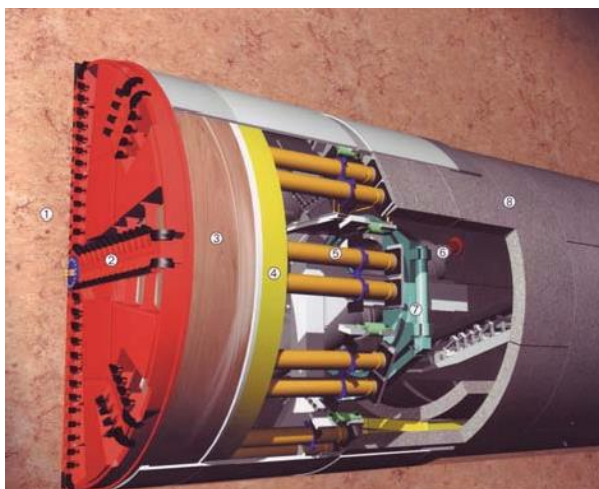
Принципова схема ТПМК «Herrenknecht» із привантаженням вибою:
